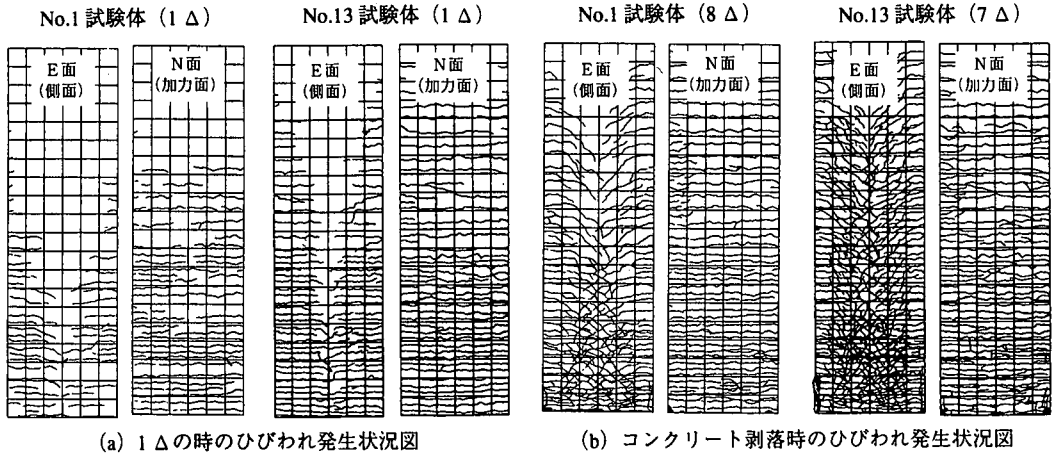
No.1試験体とNo.13試験体のひびわれ発生進行状況図
